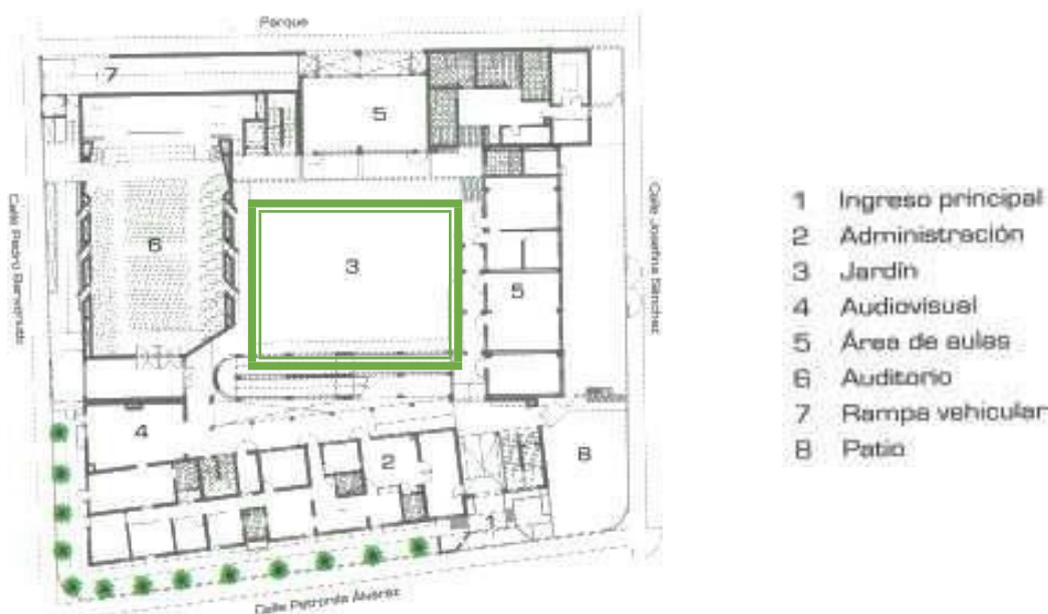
Planta del Primer Nivel, Centro Ann Sullivan del Perú
